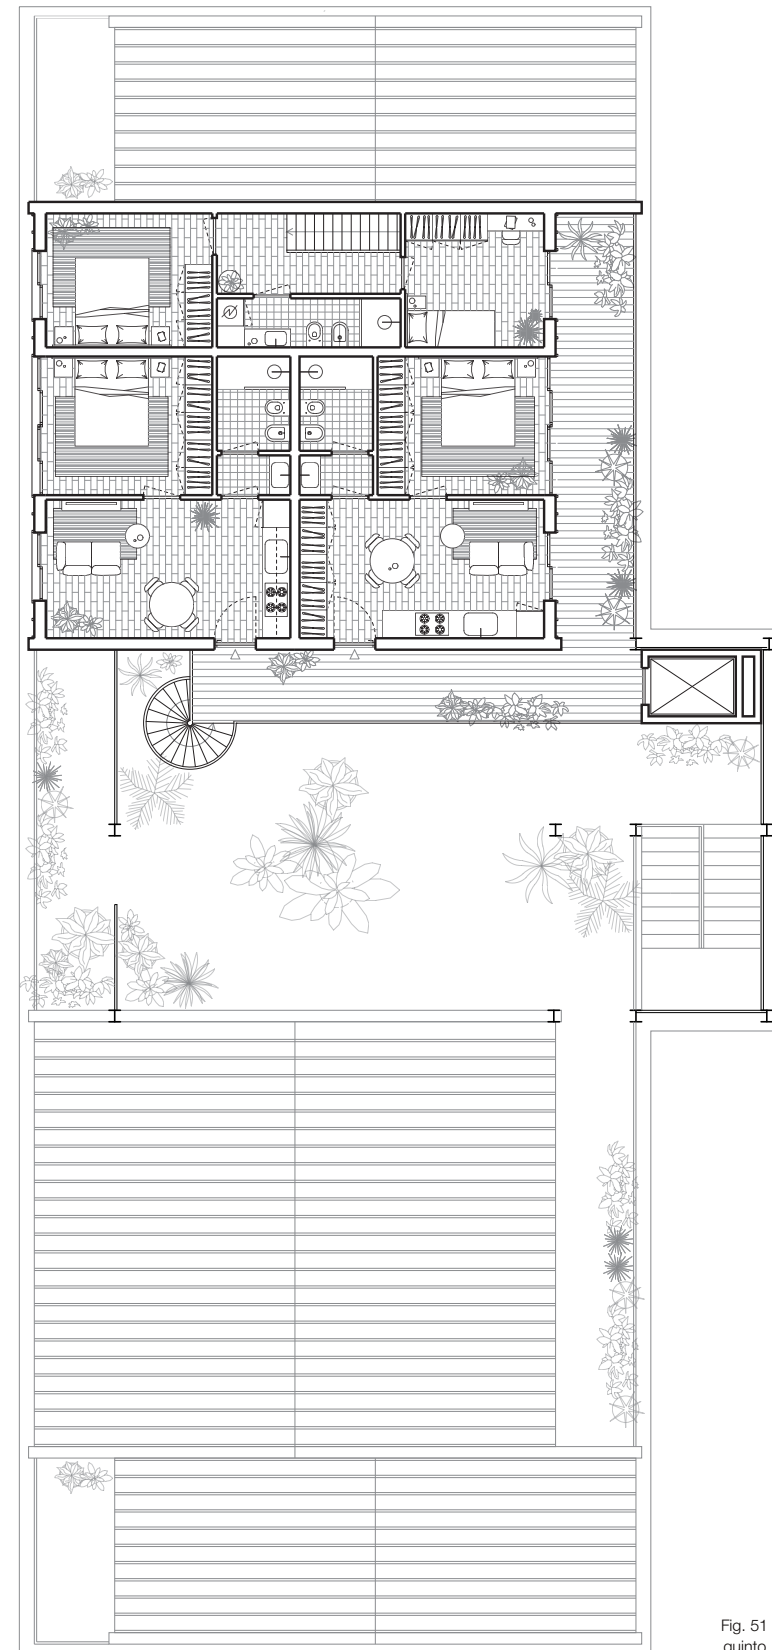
Pianta di progetto piano quinto. Elaborazione degli autori.
